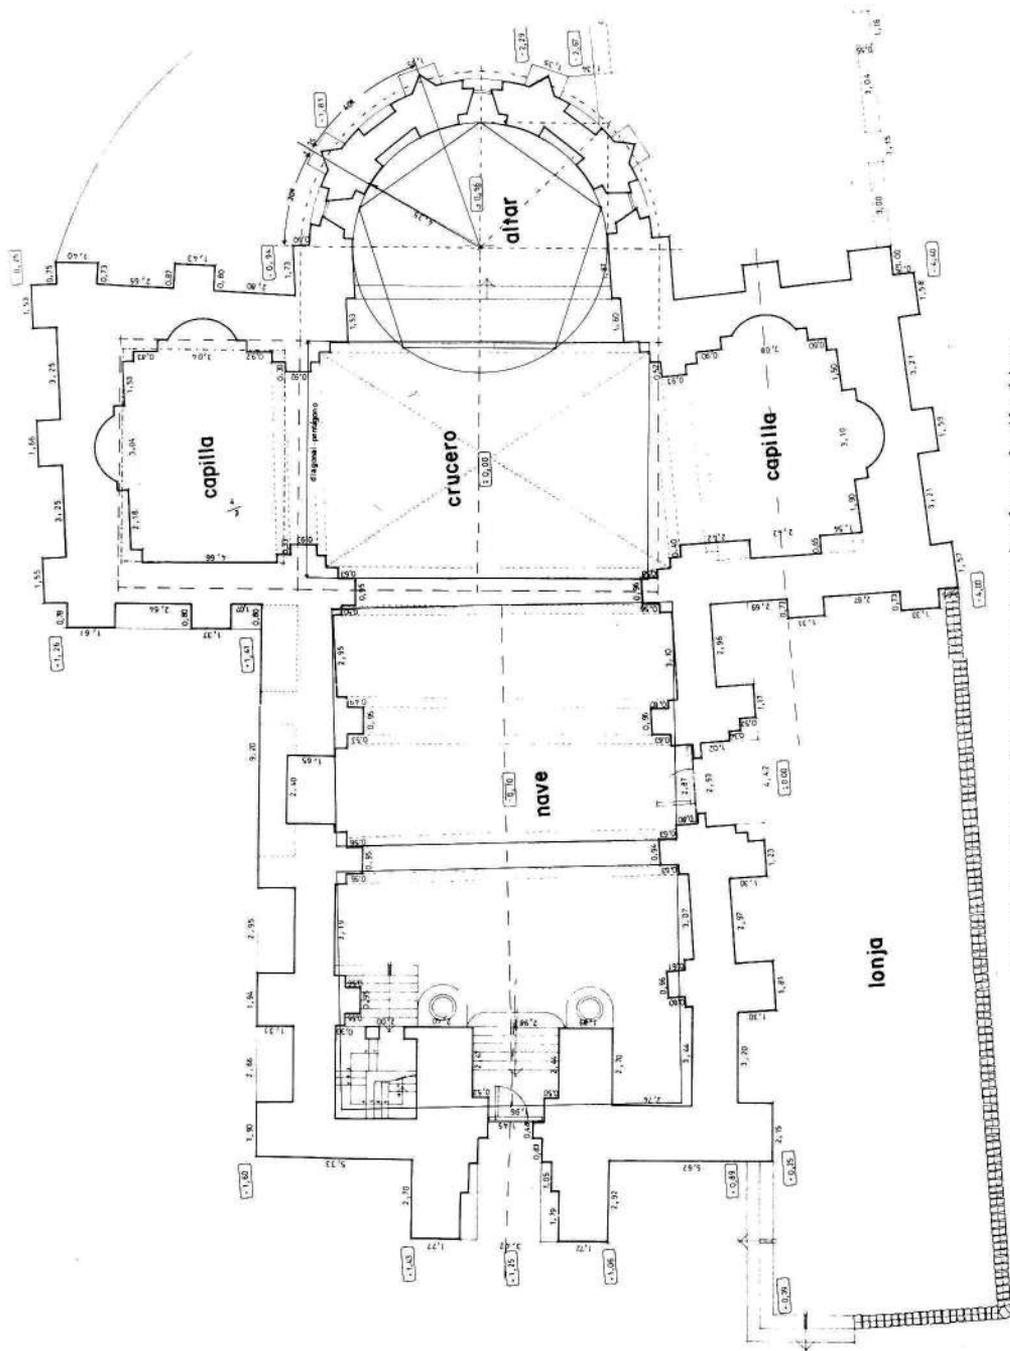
San Pedro de Siresa. Geometría en la planta de Alcubierre.
